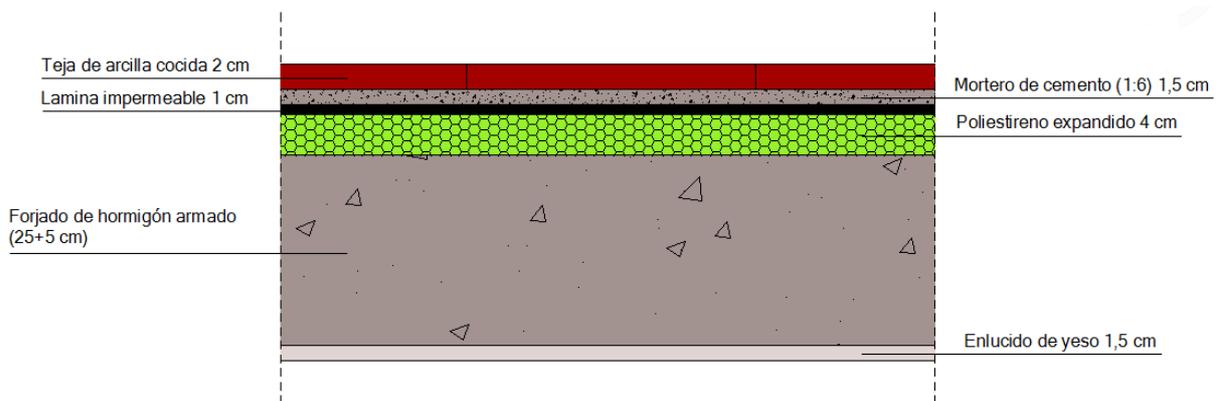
Detalle cubierta tipo 2 sin falso techo.2014.CAD.
